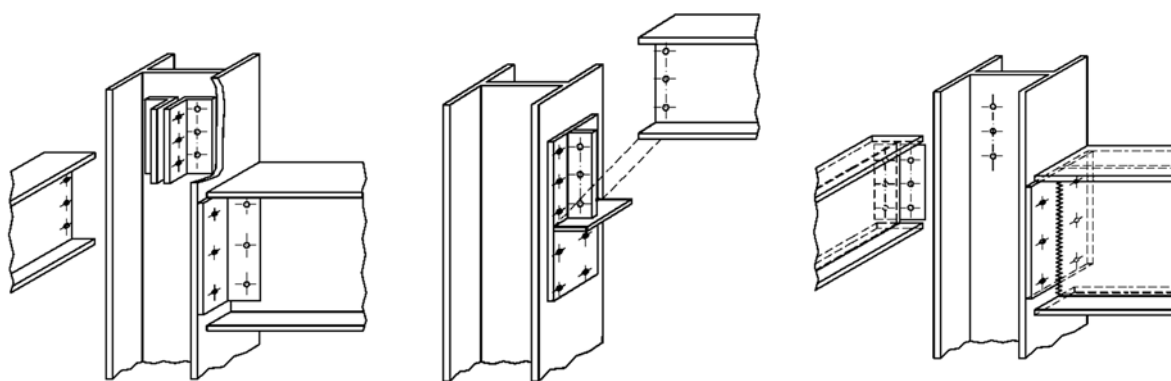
Esempi di collegamenti trave-pilastro con comportamento a cerniera
